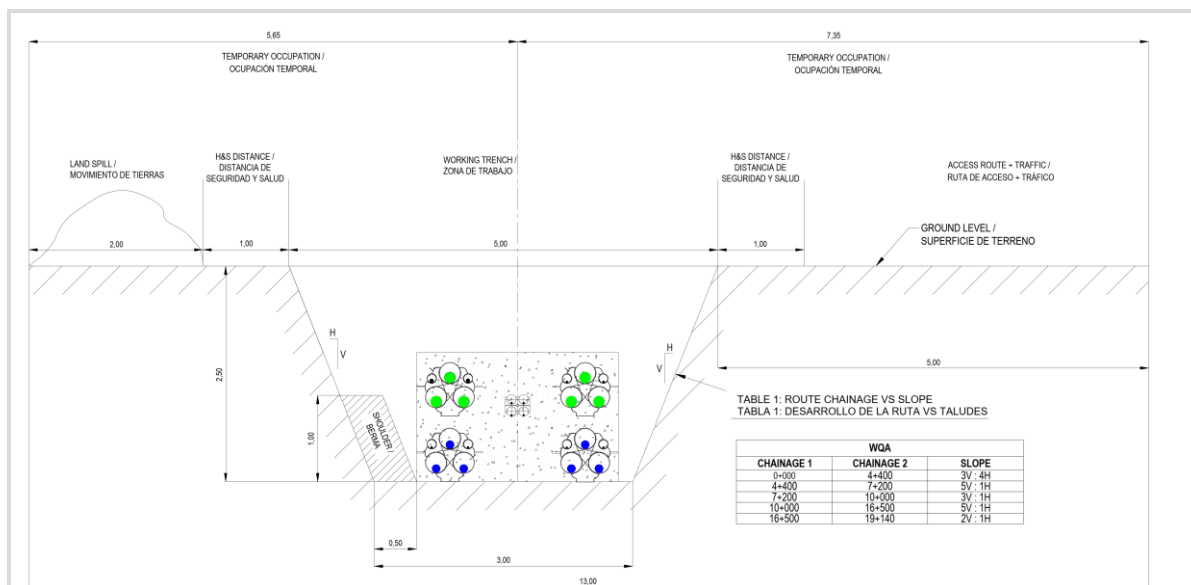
Configuración de la zona de trabajo durante la excavación de la zanja
